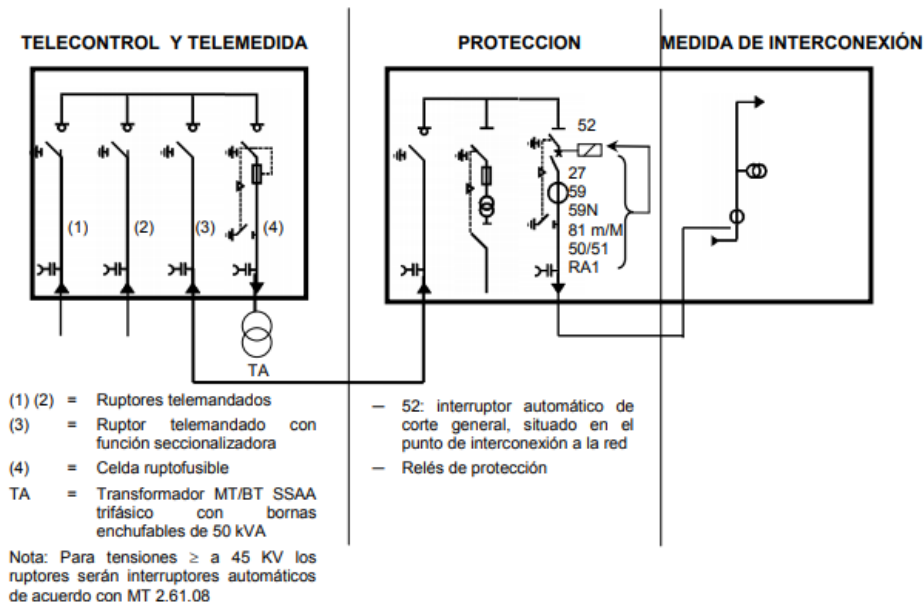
Esquema unifilar conexión Telecontrol y Telemedida al centro de seccionamiento.
